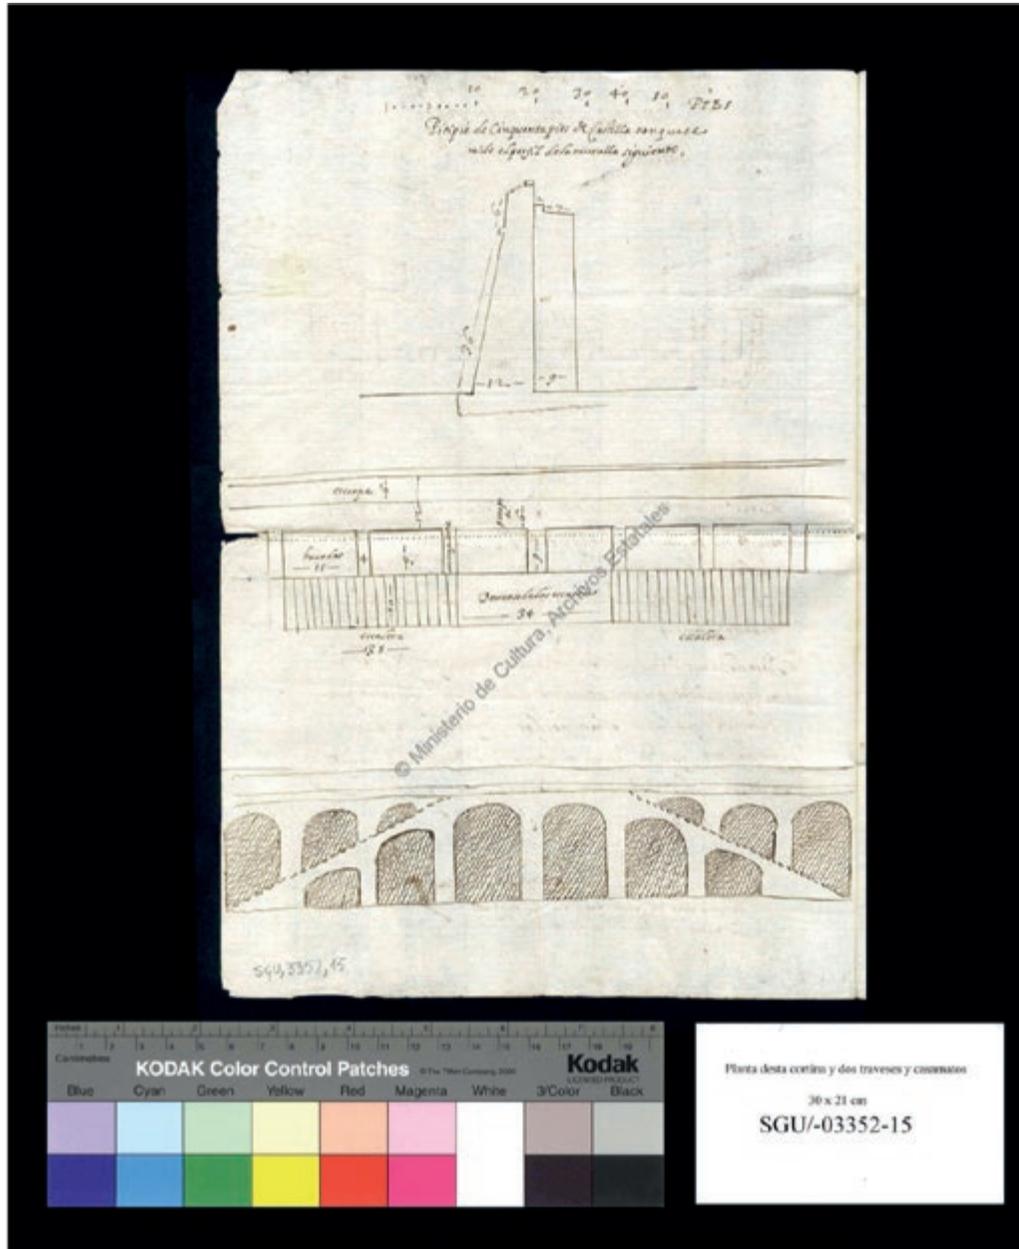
ALZADO DE LA MURALLA DE LA FORTIFICACIÓN DE MALLORCA Y PLANTA DE LA MURALLA DE LA FORTIFICACIÓN DE MALLORCA. *En ynstruccioness Para el proseguimiento dela fábrica dela Ciudad de Mallorca.* Tiburcio Spanoqui, 24 de febrero de 1601. AGS. Secretaría de Guerra, Leg. 03352, 15. Catálogo Colectivo de la red de Bibliotecas de los Archivos Estatales.
